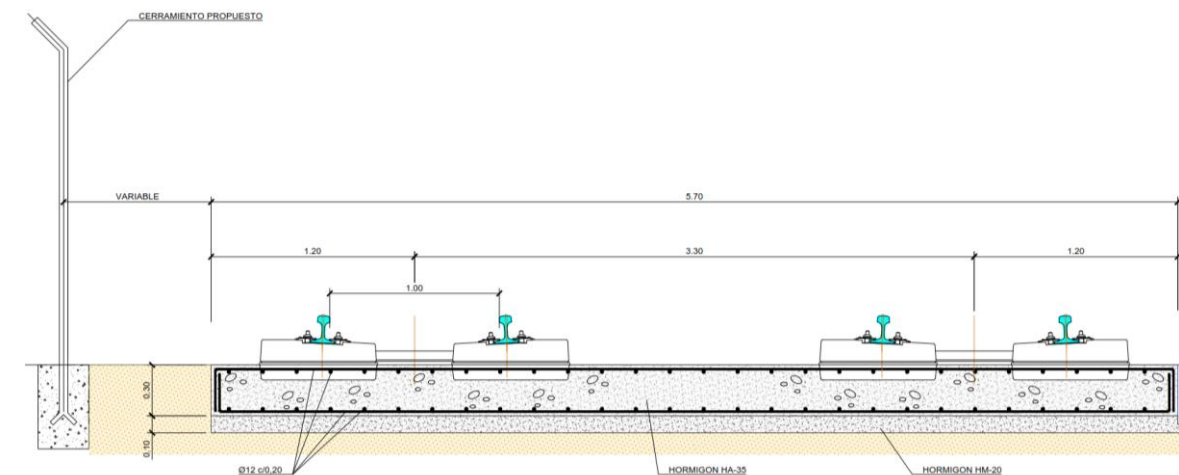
SECCION TIPO EN ANCHO METRICO
